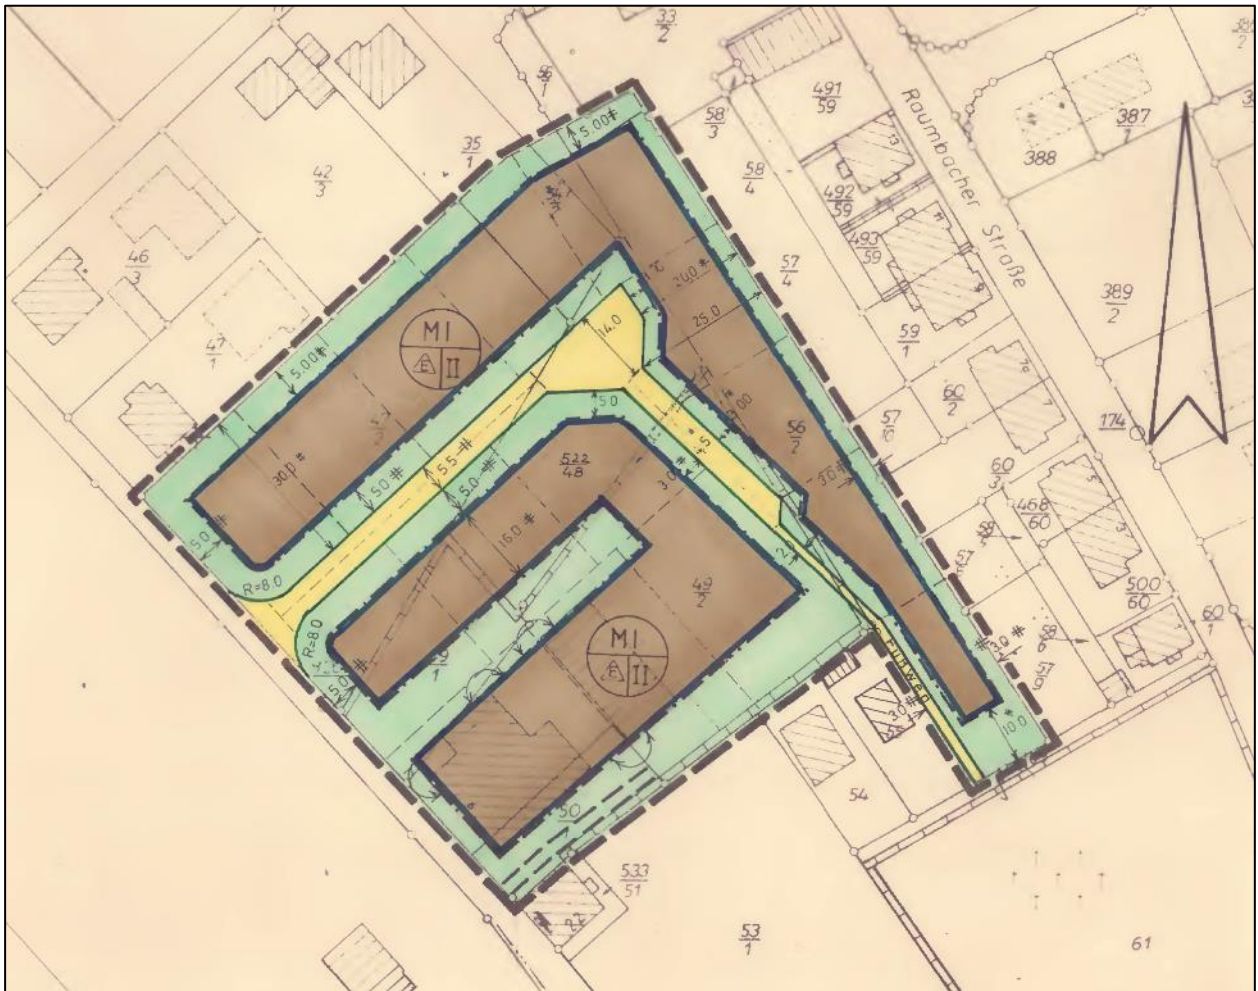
Bebauungsplan der Stadt Meisenheim für das Teilgebiet „Zwischen Raumbacher Straße und Bundesbahnstrecke“, rechtsverbindlich am 21.03.1985
